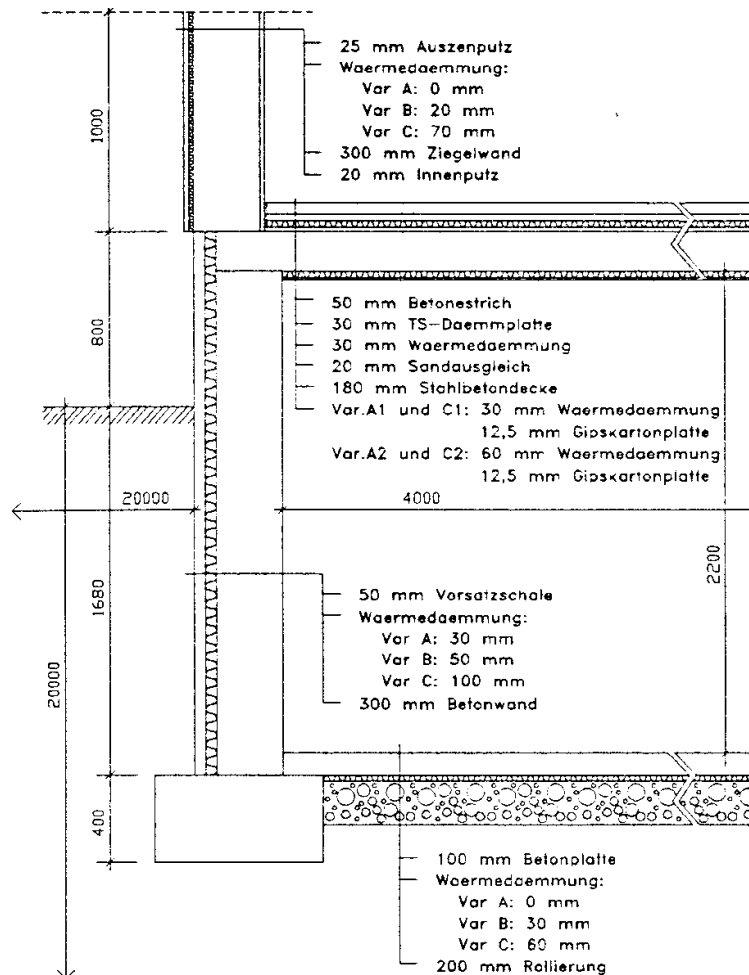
Vertikalschnitt durch das betrachtete Kellergeschoß (Maße in mm)
